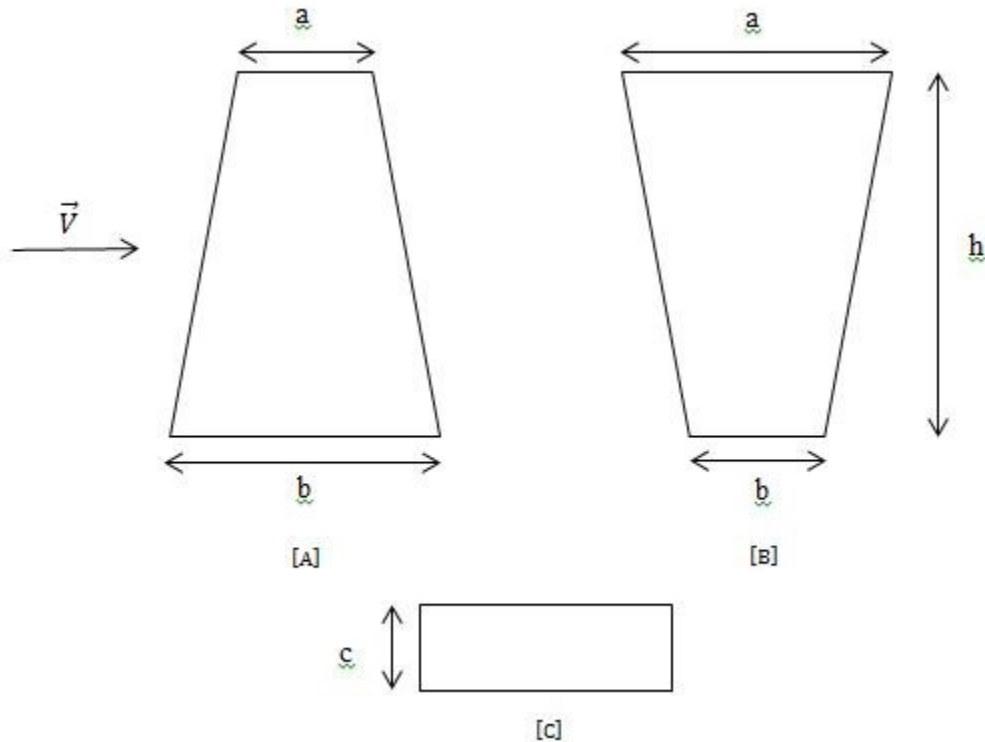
Modelos de pilar: a) pilar con el paramento inclinado hacia aguas abajo; b) pilar con el paramento inclinado hacia aguas arriba; c) sección transversal.
